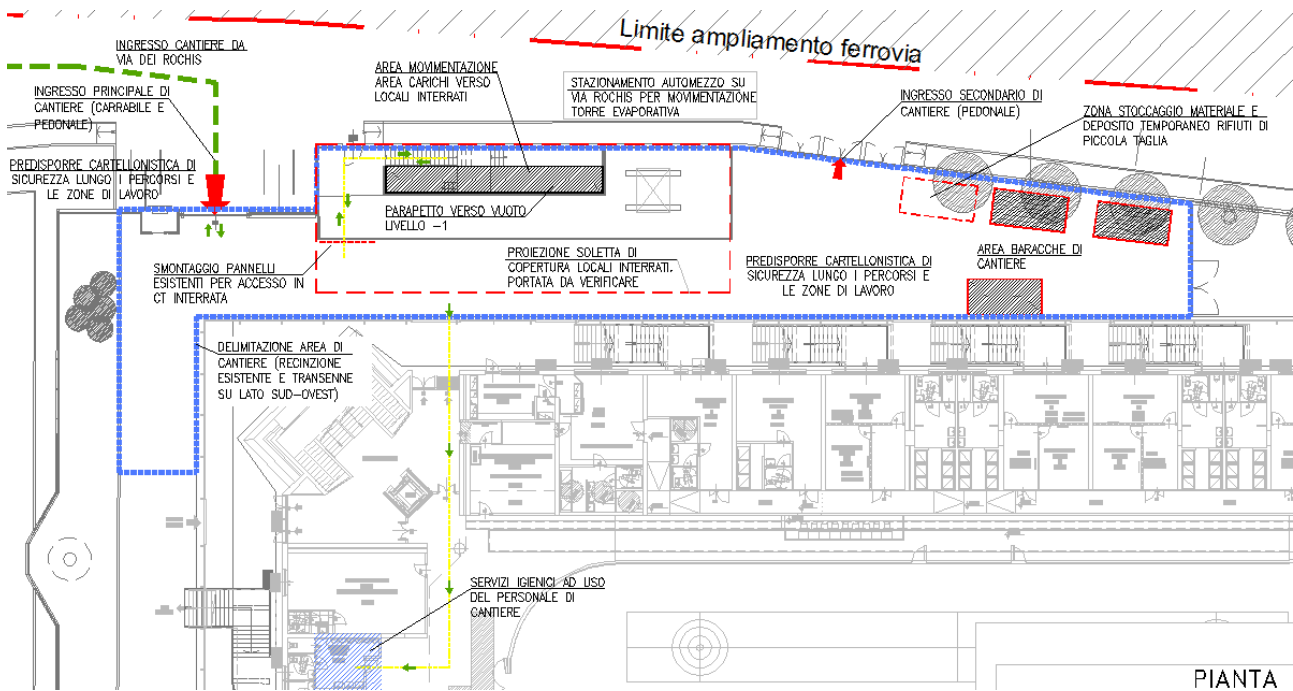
Stralcio planimetria di cantiere (si veda l'allegato B del PSC)
